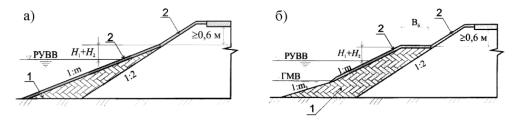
Конструкции укрепления откосов связными грунтами: a — присыпной призмой без бермы; δ — присыпной призмой с бермой: H_1 — запас высоты укрепления; H_2 — высота укрепления в зоне волнового воздействия; m — заложение откоса, динамически устойчивого к волновому воздействию (m = 3...15); m_1 — заложение откоса при свободной отсыпке грунта в воду (m_1 = 1:2...1:3); B_6 — ширина бермы по ОДМ 218.2.078—2016; I — призма из глинистого грунта; 2 — укрепление растительным грунтом с посевом трав
